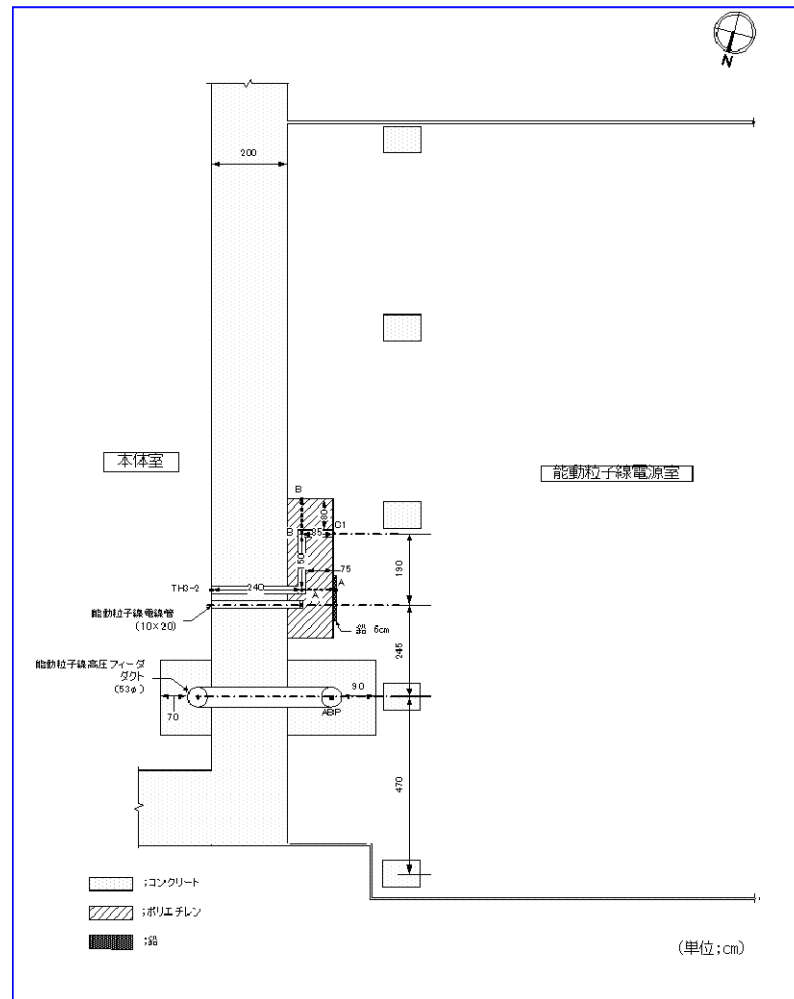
1. 8. 15 能動粒子線電源室 ダクト配置図(平面図) (単位 cm) (改修前)
